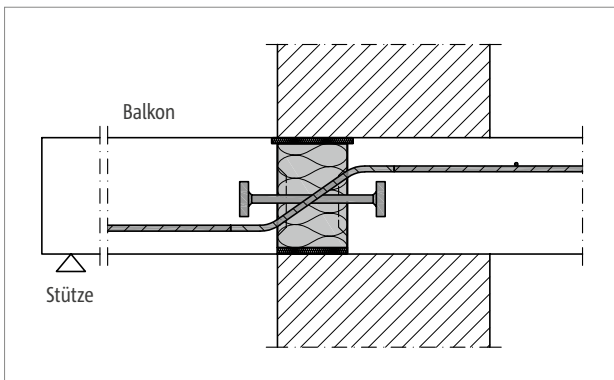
Schöck Isokorb® XT Typ QP: Anschluss gestützter Balkon bei einschaligem, wärmedämmendem Mauerwerk
